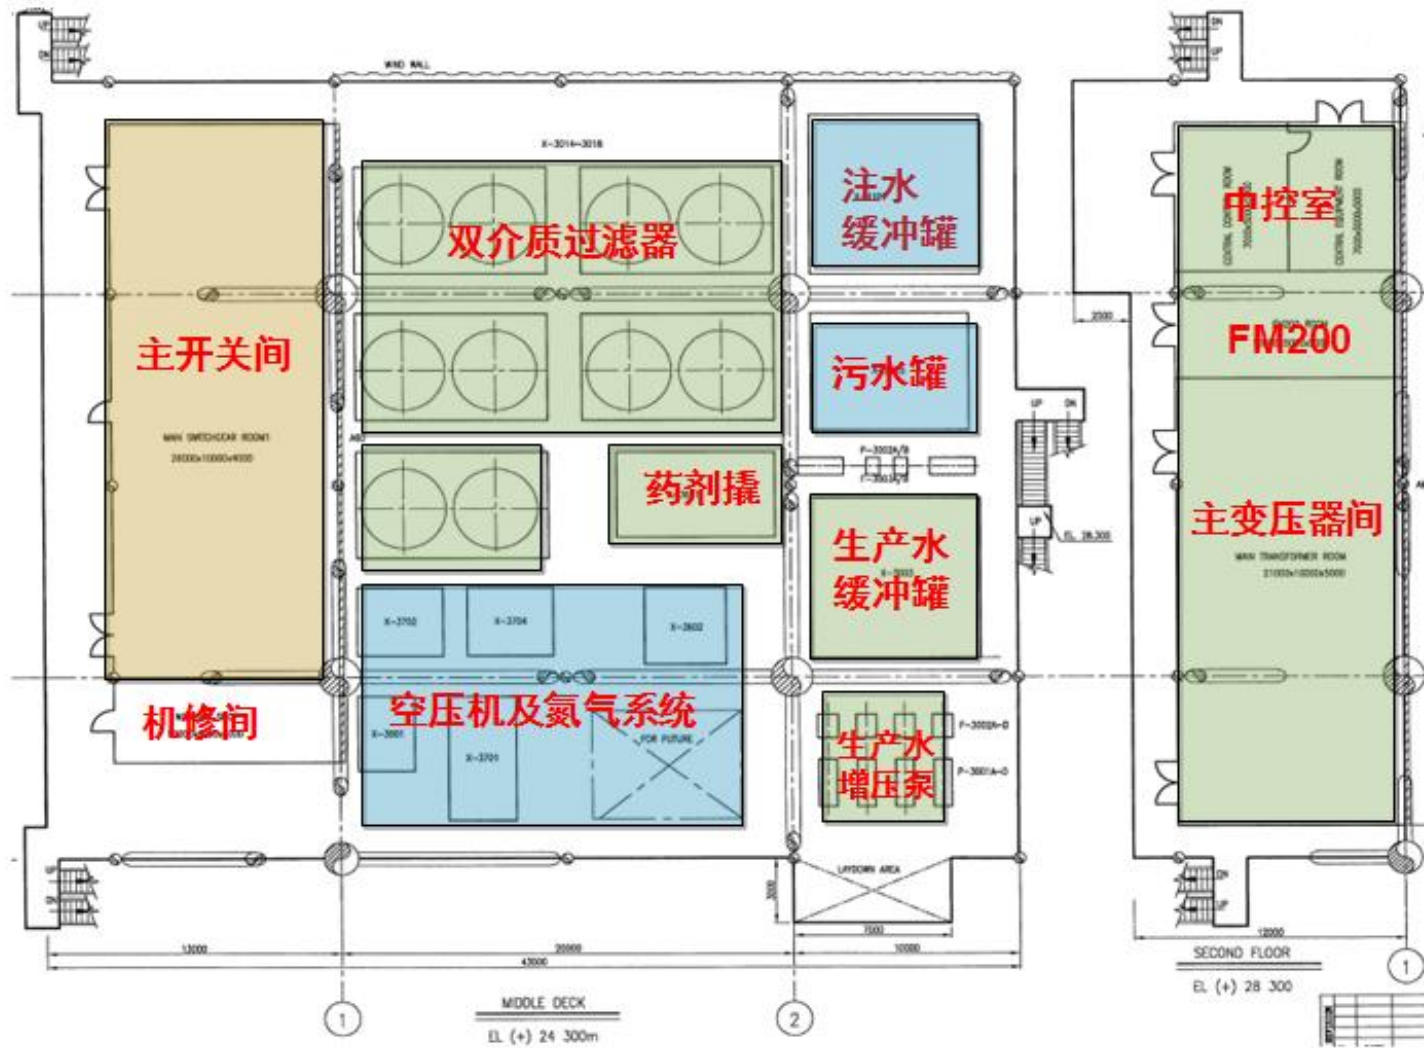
QHD32-6CEPK 中层甲板平面布置图
